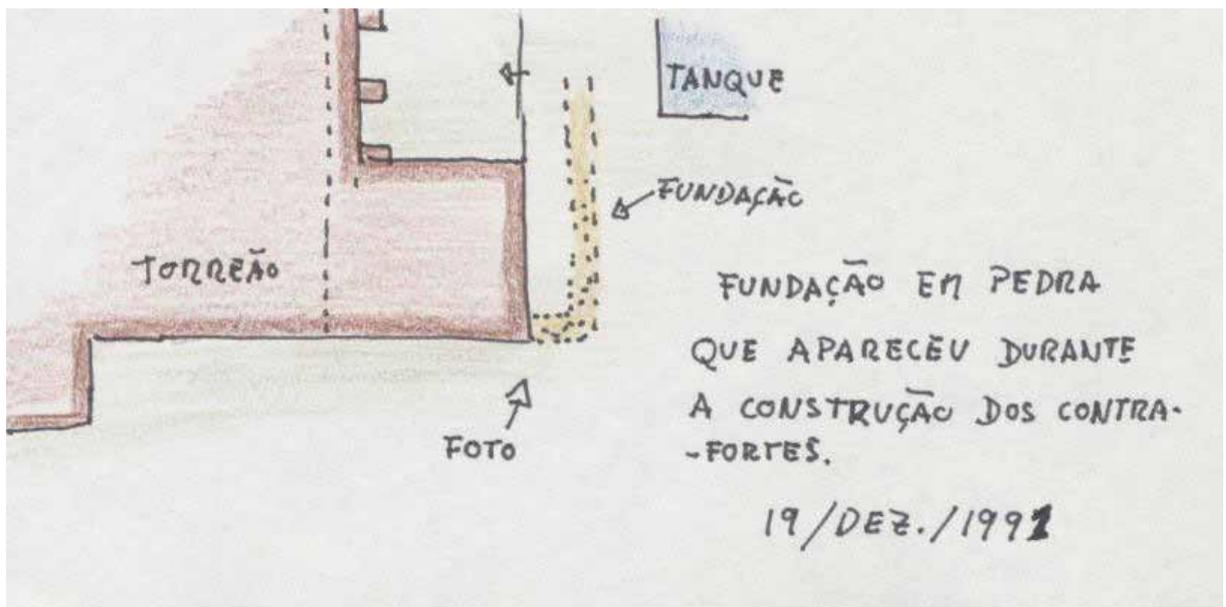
Esboço assinalando as fundações encontradas junto da fachada nascente (imagem cedida pelo arquiteto João Rito Afonso)
